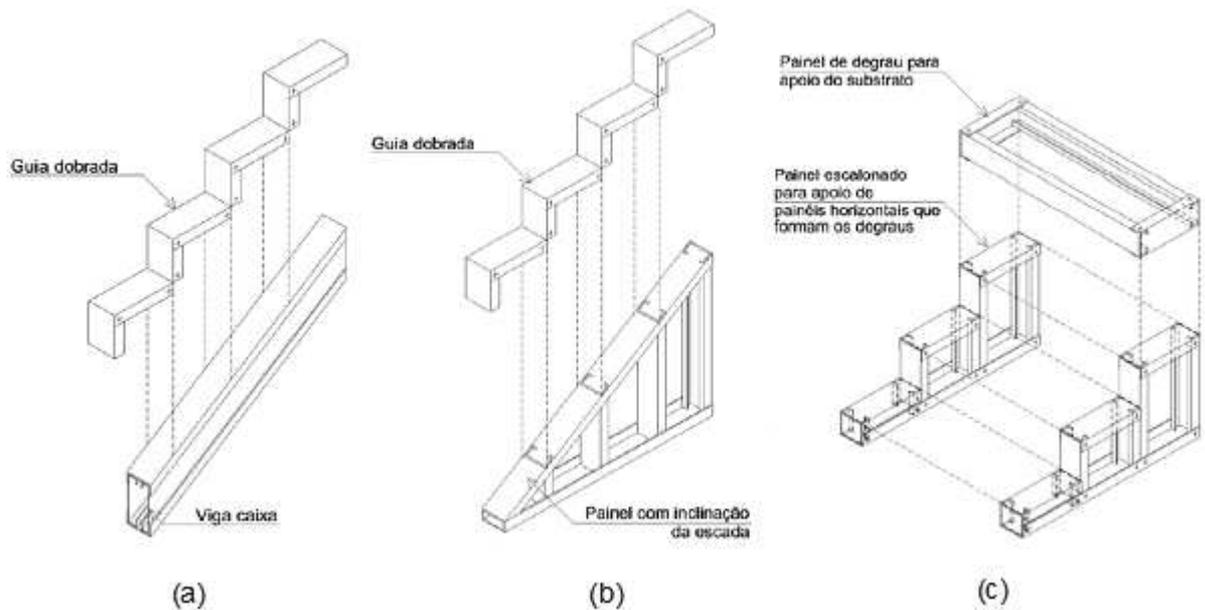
Escadas: (a) viga caixa inclinada; (b) painel com inclinação; (c) painéis escalonados
